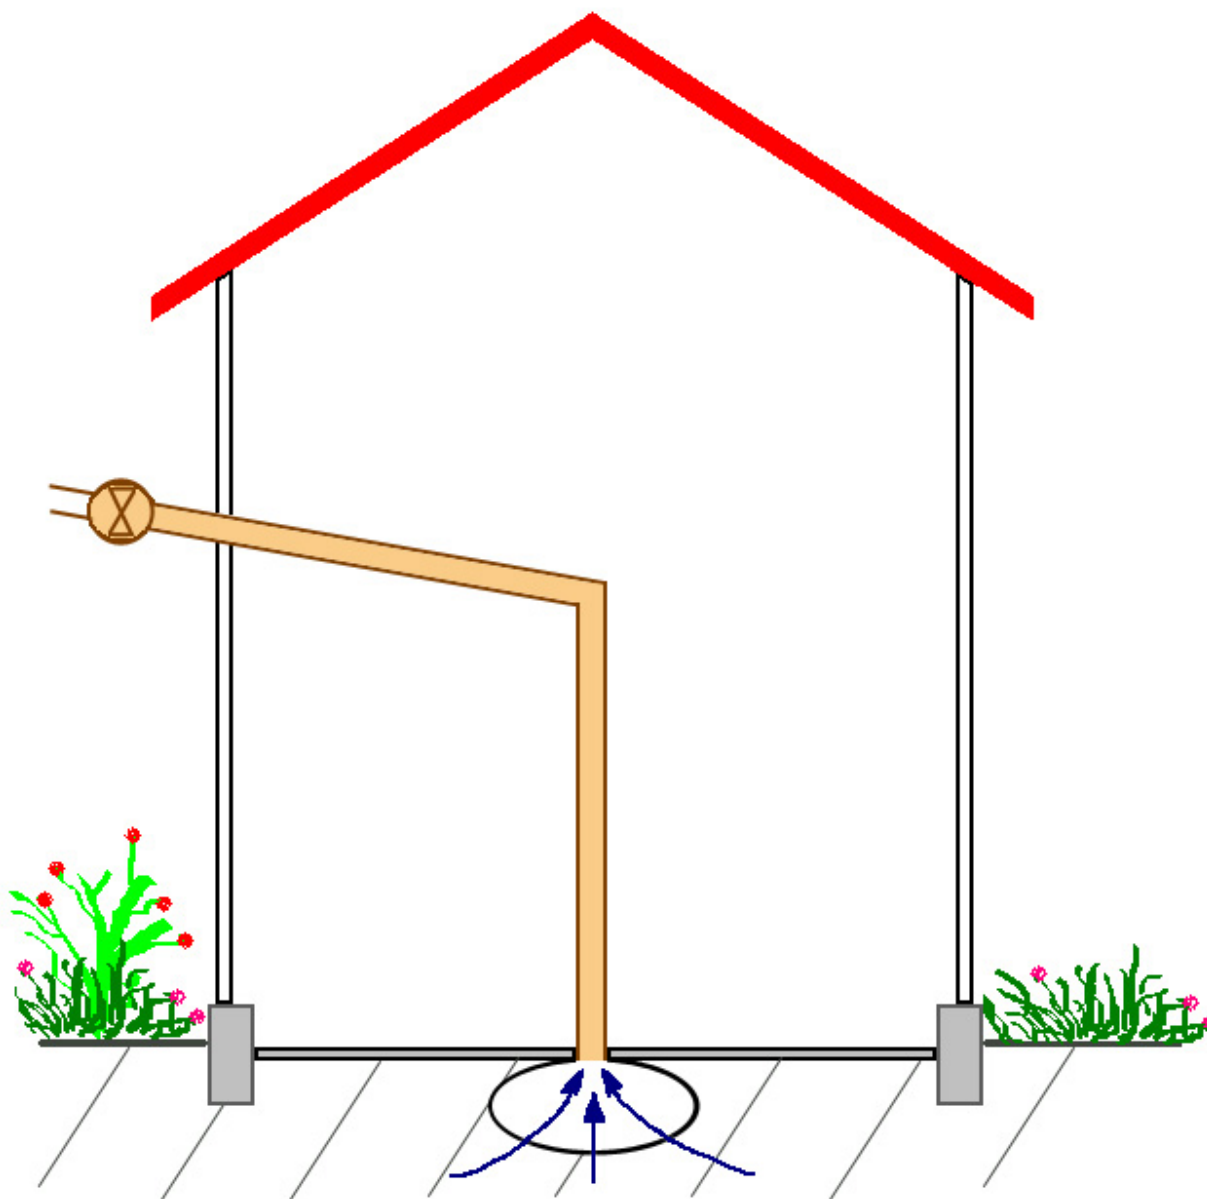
Здание на монолитной бетонной плите с установленной системой откачки воздушно-радоновой смеси из-под фундамента. Вытяжной вентилятор создает под плитой область пониженного давления, препятствуя поступлению насыщенного радоном грунтового воздуха внутрь здания. Точка ввода трубы должна располагаться как можно ближе к центру плиты. Чтобы создать под зданием как можно более протяженную область пониженного давления, под плитой должна быть выкопана яма
